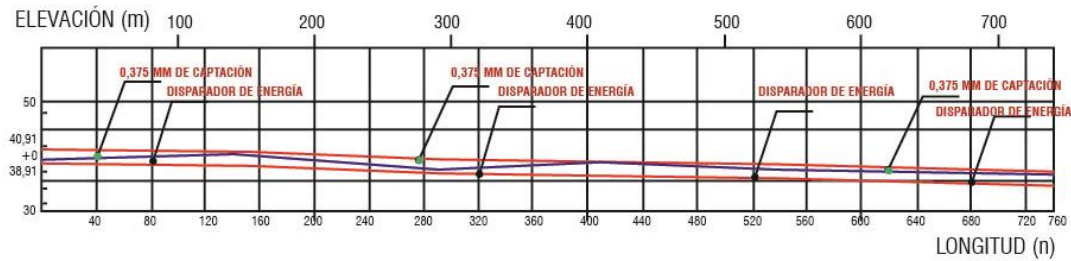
Perfil longitudinal propuesto para el eje del canal.
